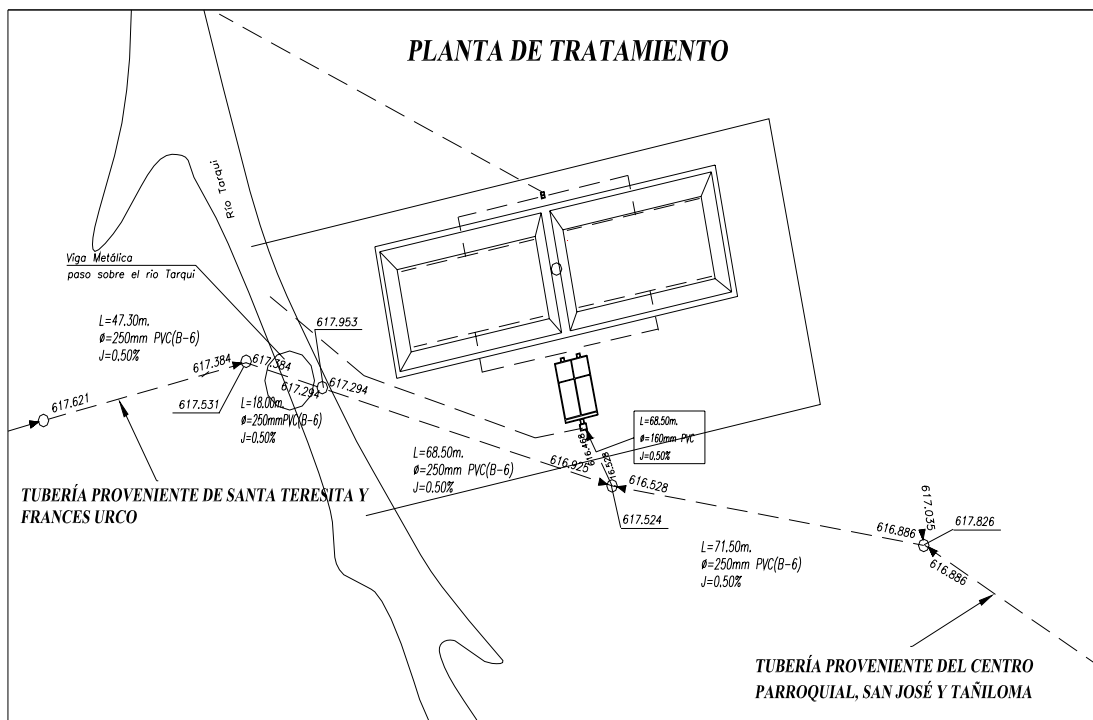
Tuberías de llegada a la PTAR (ETAPA, 2005. Terreno Planta Tarqui.
